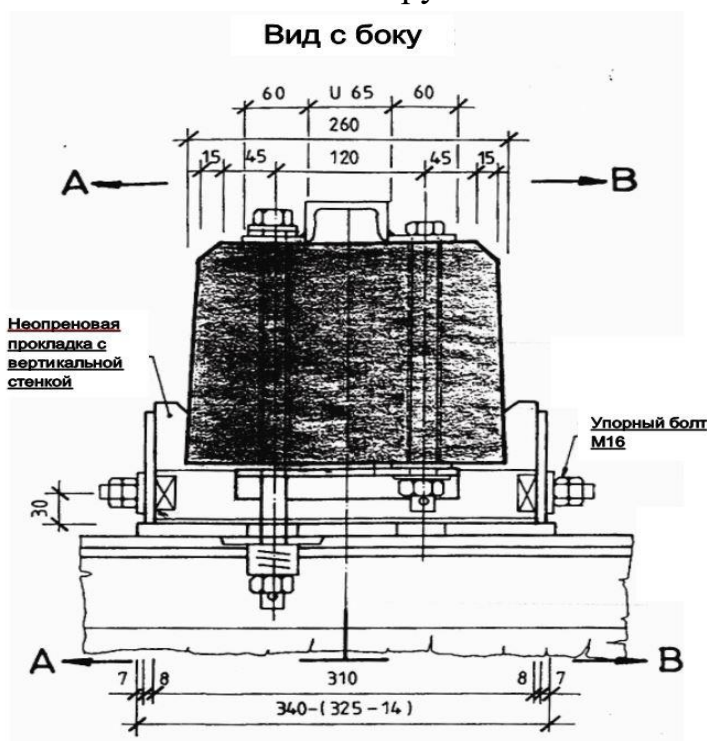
Вид с боку конструкции башмака и неопреновой прокладки с вертикальной сткнкой
